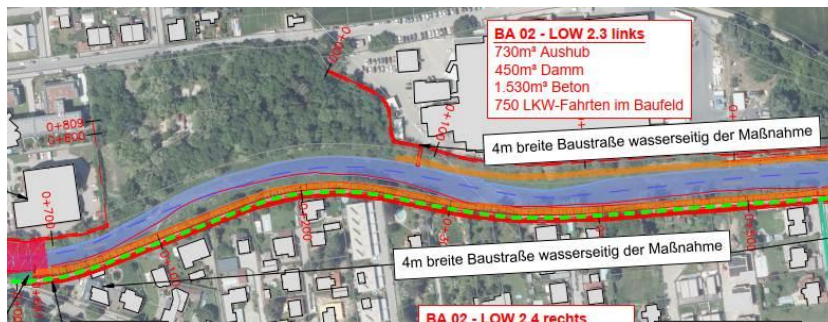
Waldfläche mit Waldspielplatz, Ausschnitt Übersichtslegeplan Baustellenkonzept BA02 (Quelle: Einreichoperat, Einlage 264)
